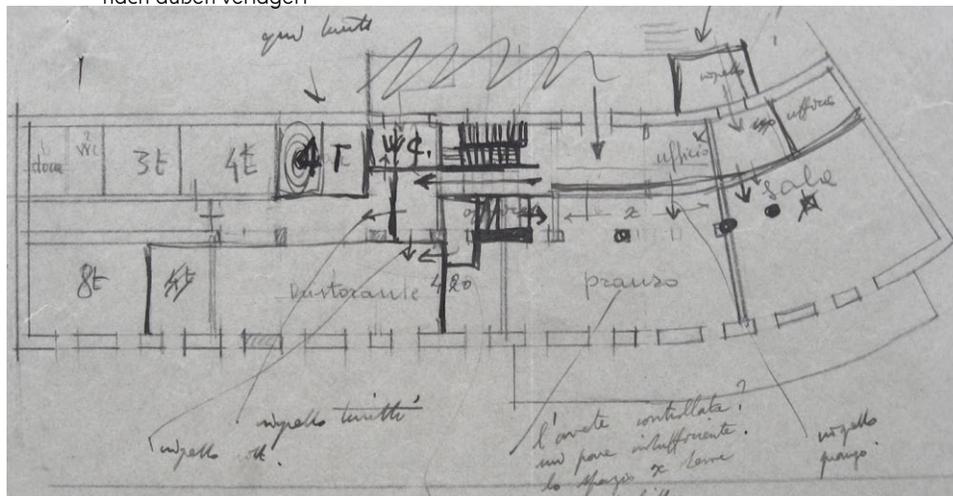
Grundriss 1.OG mit innen liegender Erschlieung
